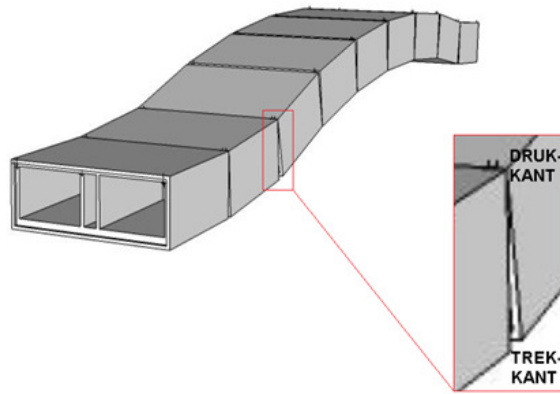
Verhinderen van verticale vervorming bij zakkings van segment A t.o.v. segment B
